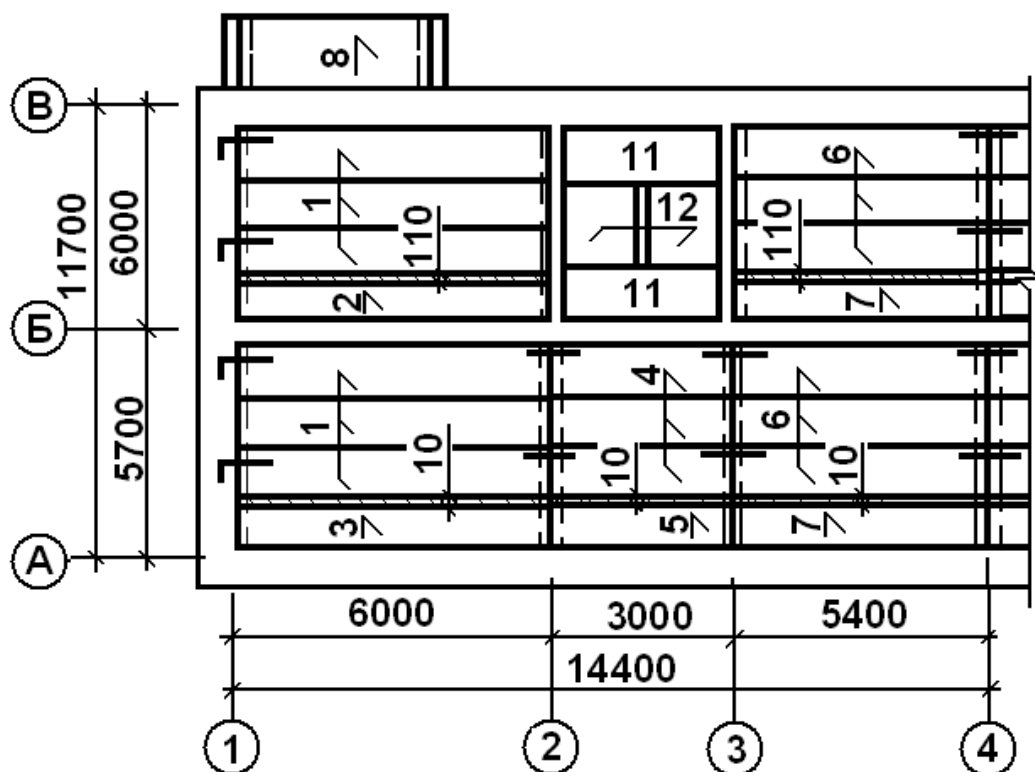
Пример плана перекрытия для здания с поперечными несущими стенами
